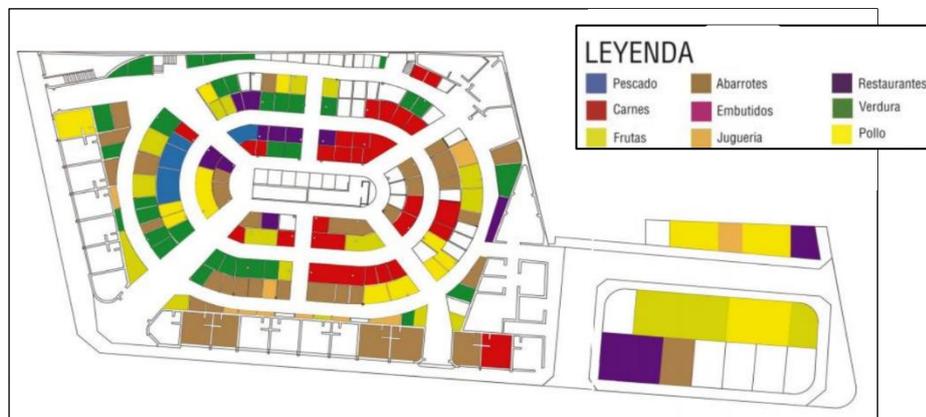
Planta esquemática del 1º Nivel del mercado de Surquillo
